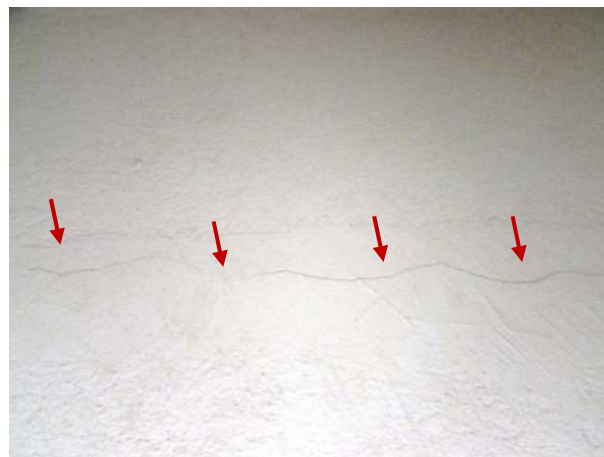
Detalhe das fissuras horizontais na parede sob a escada
